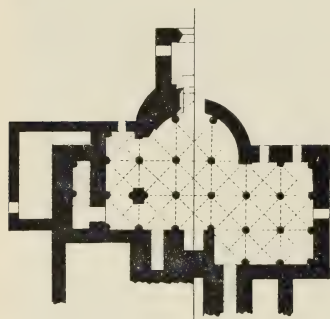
Brauweiler. Grundriss der Krypta.
